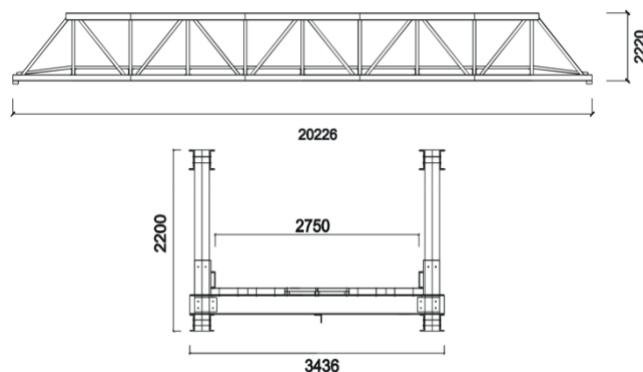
Elevação longitudinal e seção transversal da ponte (dimensões em mm)
